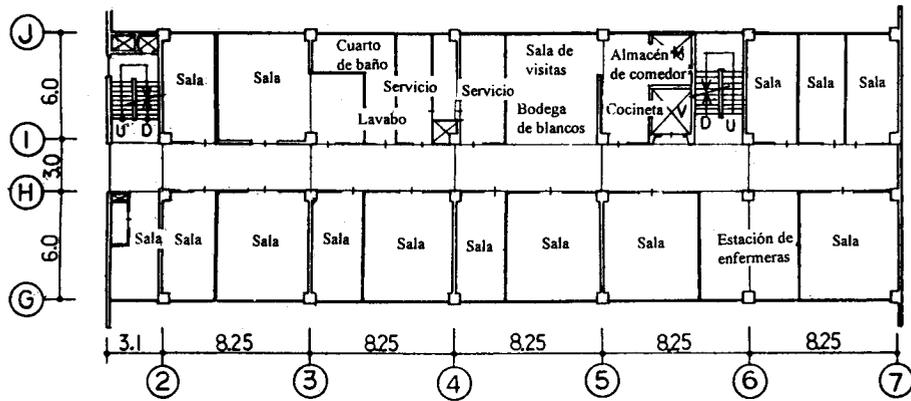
Planta del tercer nivel (Distribución de salas en el edificio de 5 niveles)
